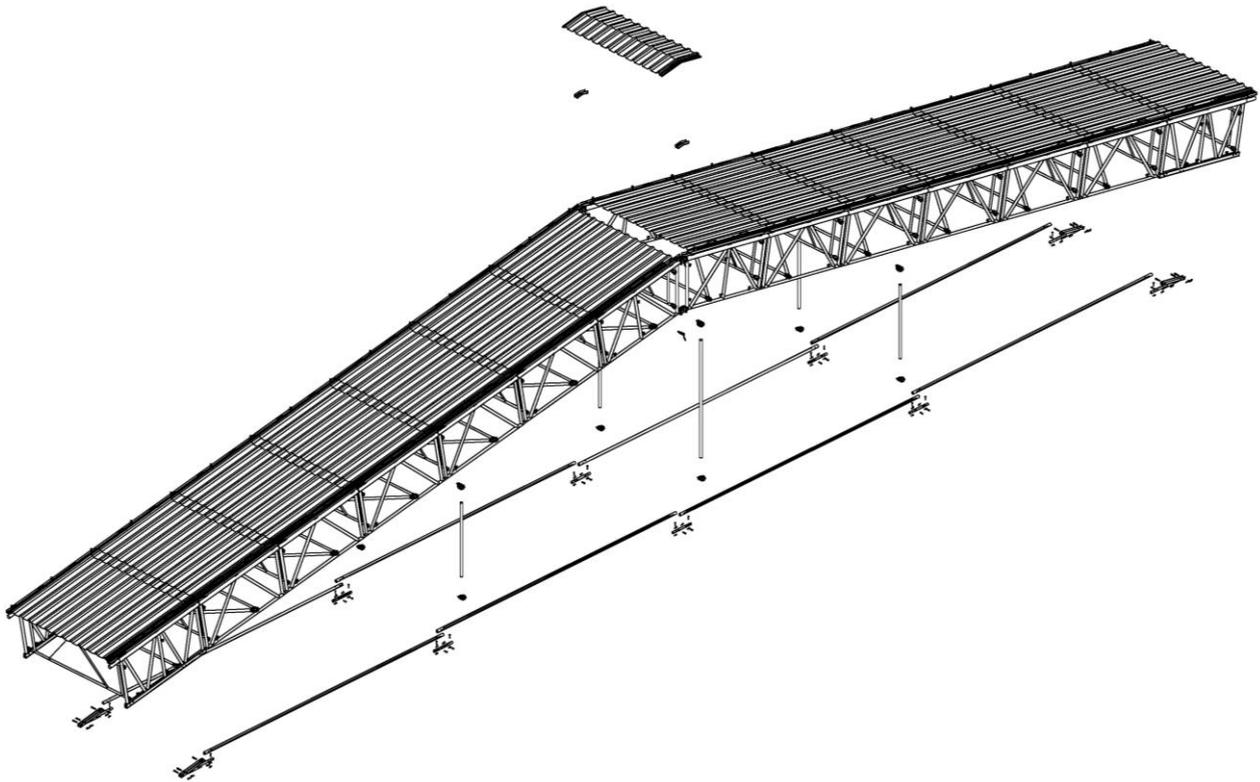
Vervollständigung des Firstes mit anschließender Montage des Zugbandes
